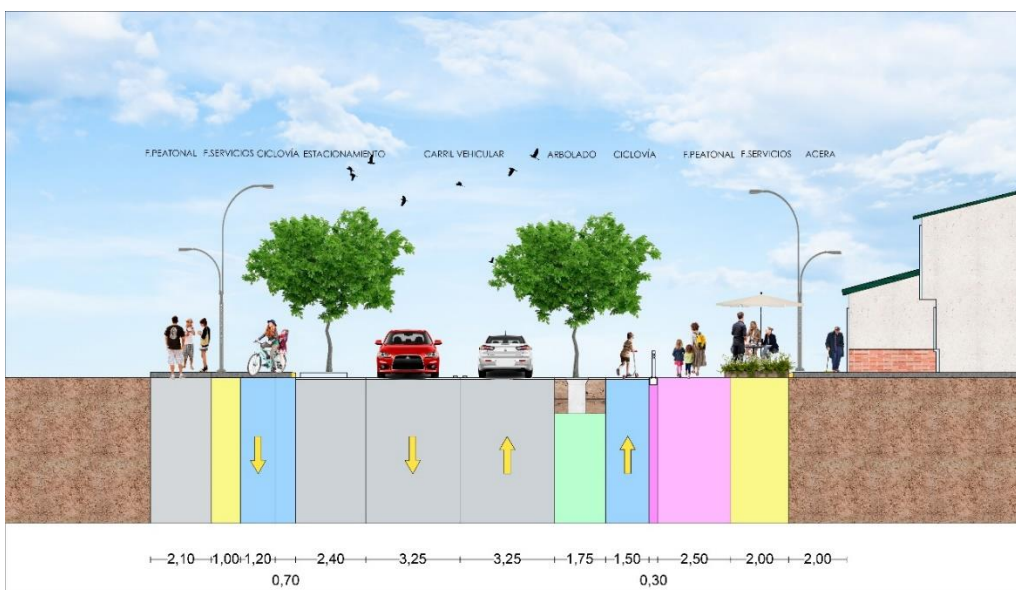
Sección B-B' (Corte vial tramo 2).
